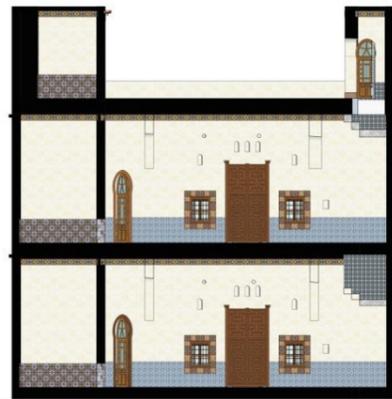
Coupe sur la façade intérieure NORD. (Source Auteure).
